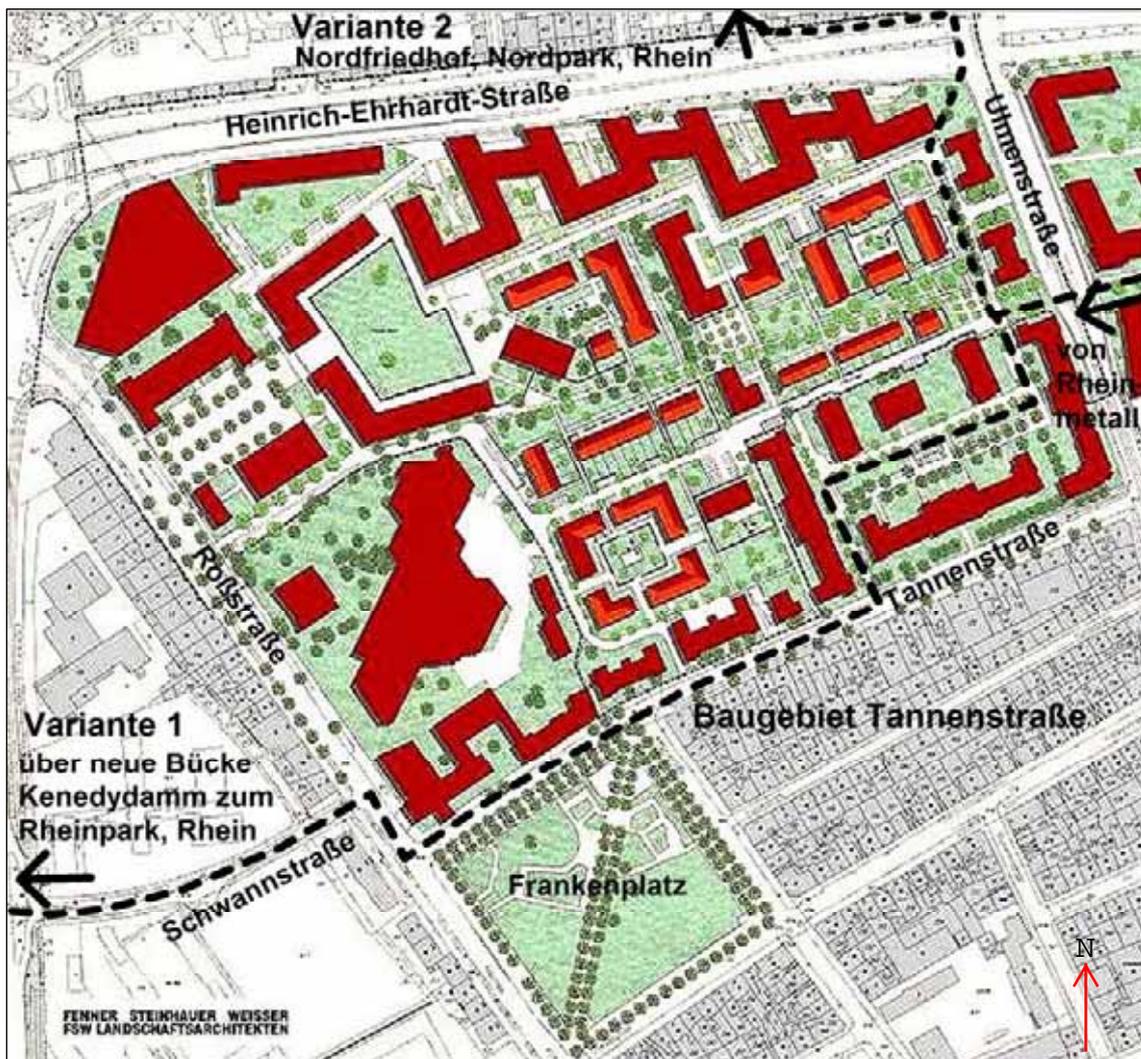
Plan Baugebiet Tannenstraße mit Verlauf des Grünen Rings
